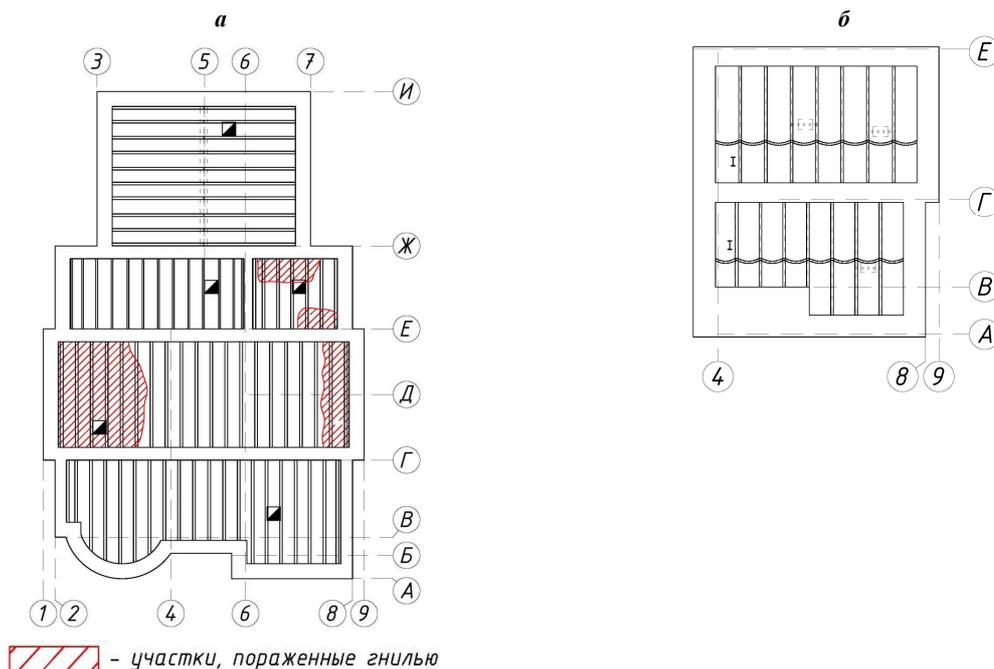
Схемы перекрытий с указанием мест дефектов: чердачное (а); над подвалом (б)
